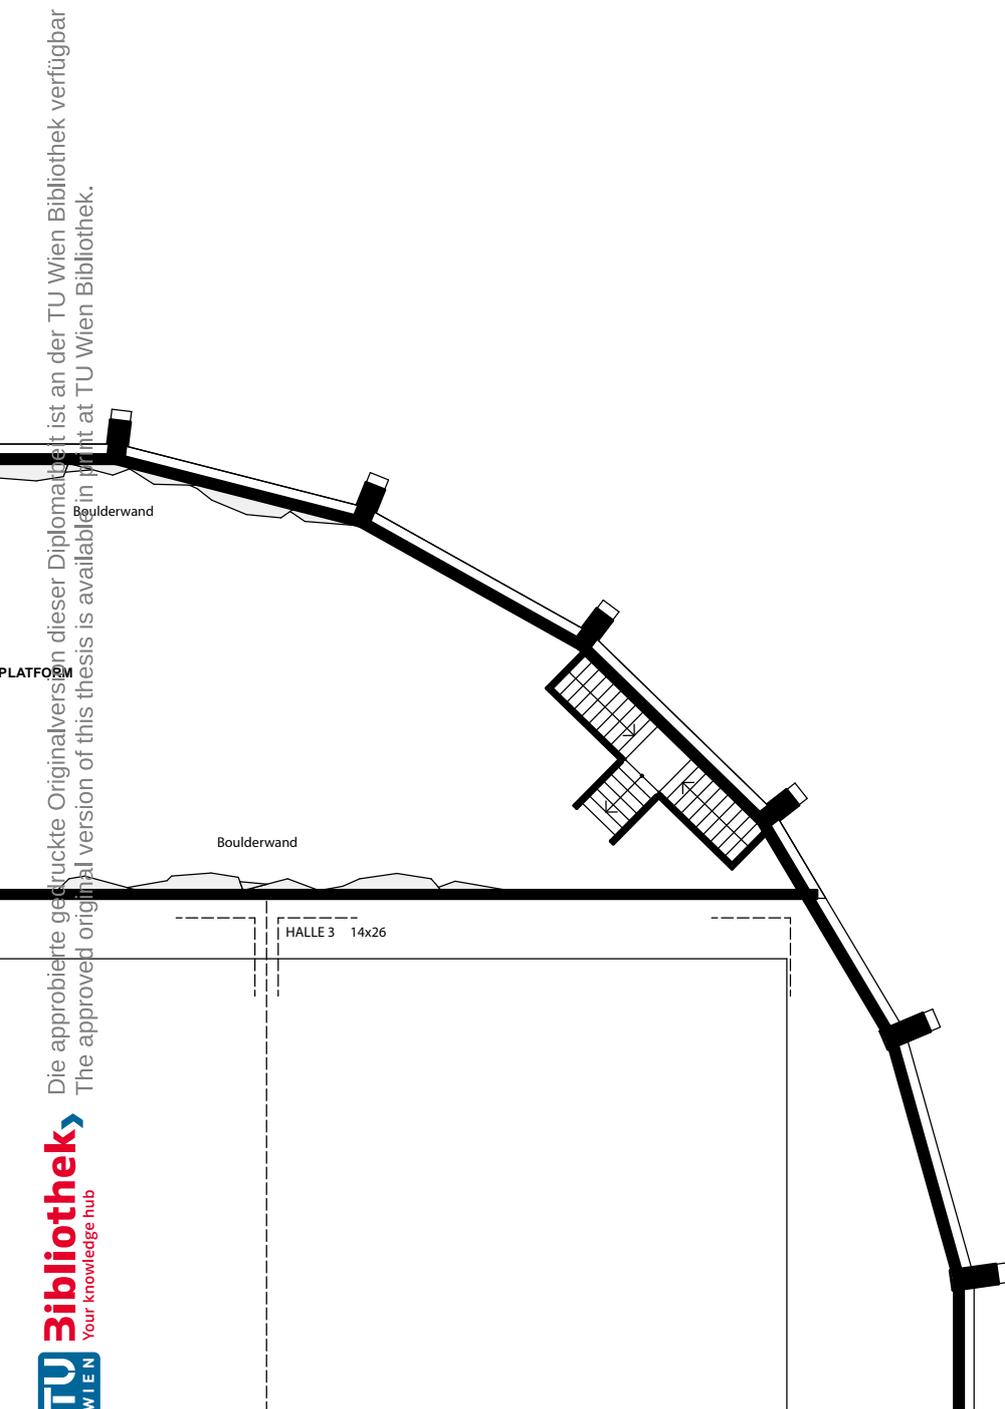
Grundriss 1. OG: Nordseite
